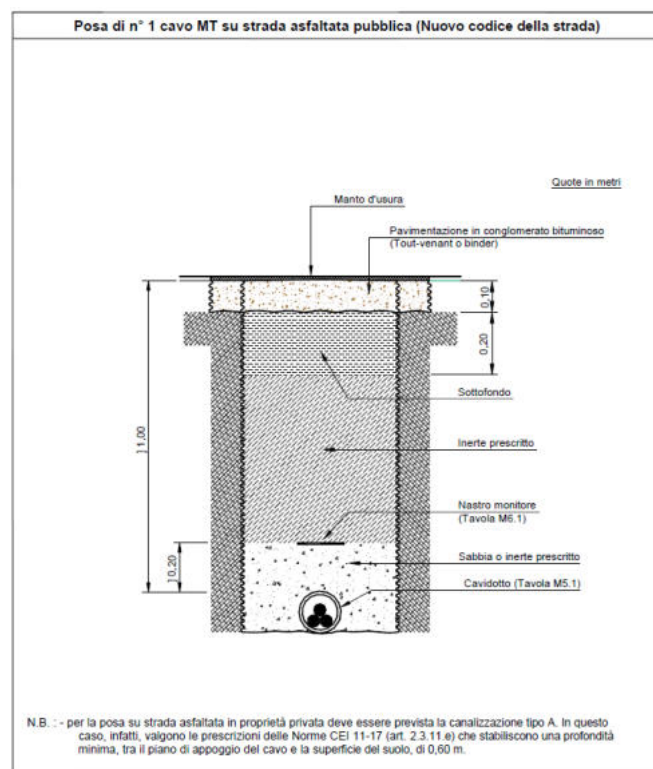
Sezione tipica di posa della linea in cavo in MT su asfalto
